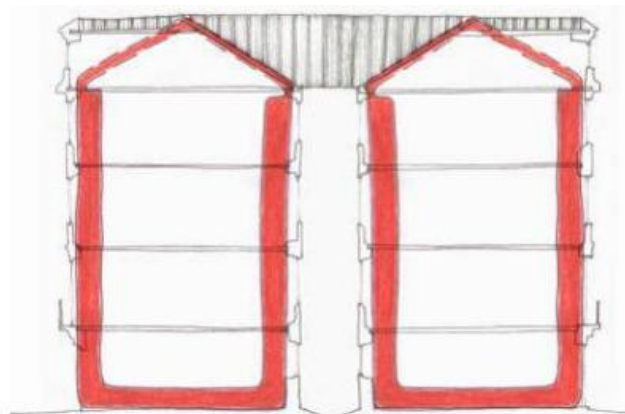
Forte inércia térmica (Evangelista, 2008).
